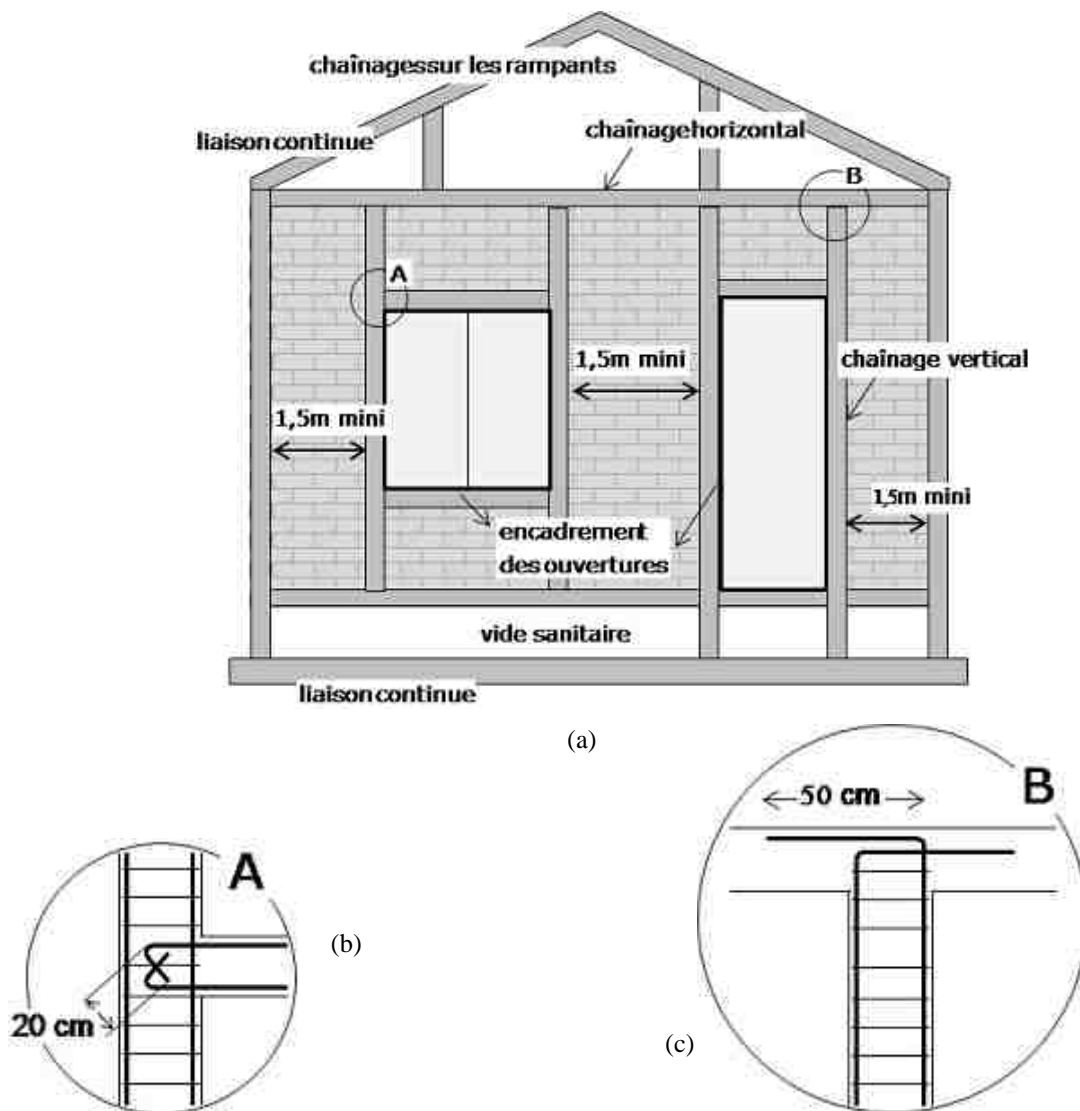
exemple de (a) chaînages d'encadrement des ouvertures d'un mur en maçonnerie, (b) croisement des raidisseurs horizontal et vertical et (c) croisement du raidisseur vertical et du plancher
